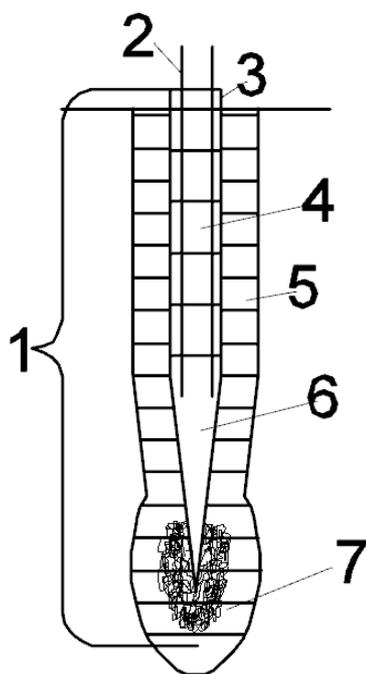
Конструктивная схема набивных раскатных свай с уплотненным щебнем забоем: 1 – тело сваи; 2 – армирование сваи; 3 – оголовок; 4 – бетонная с армированием часть сваи; 5 – уплотненная зона грунта околосвайного массива; 6 – коническая часть; 7 – уплотненный щебнем забой скважины (сваи)
